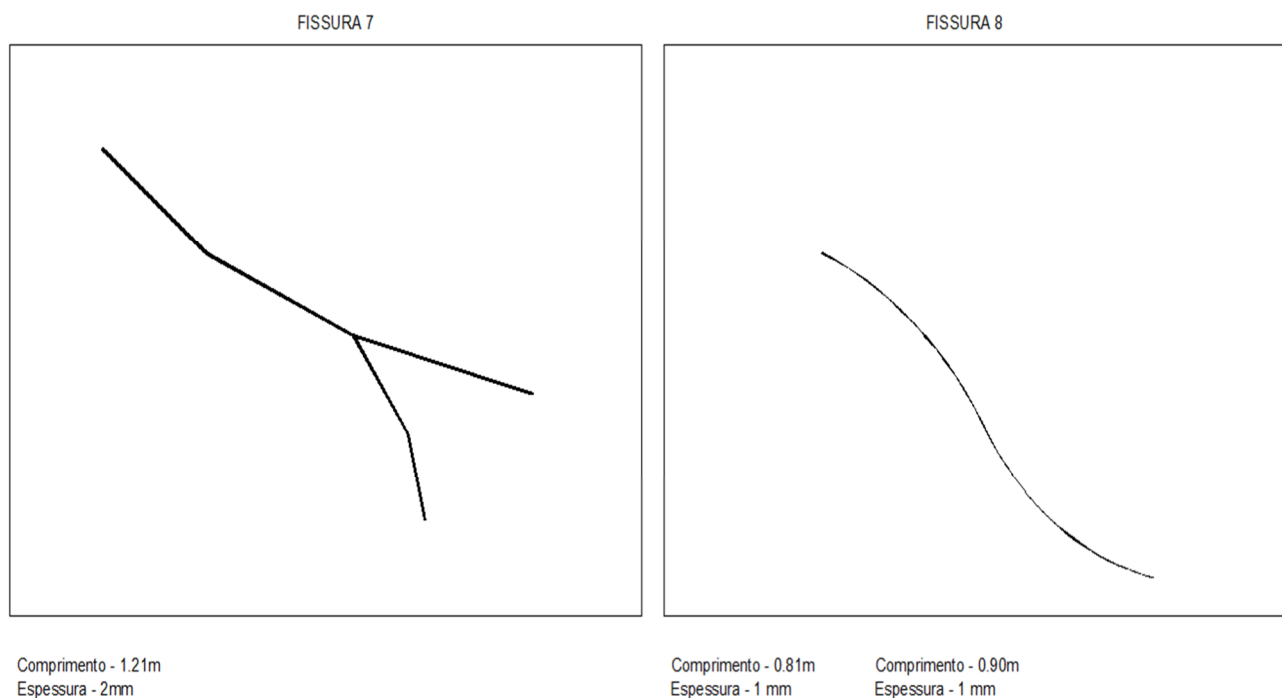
Fissuras 7 e 8 criadas em AutoCAD
